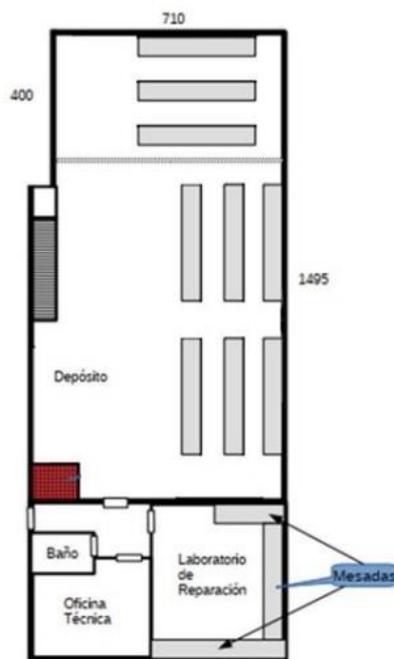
Nuevo Layout con estanterías. Fuente: propia
